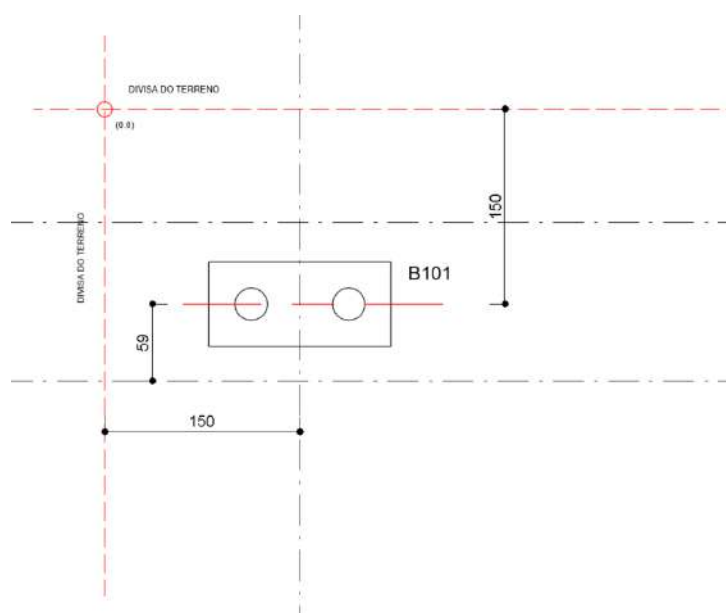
Vista da planta de locação dos pilares gerada automaticamente.
